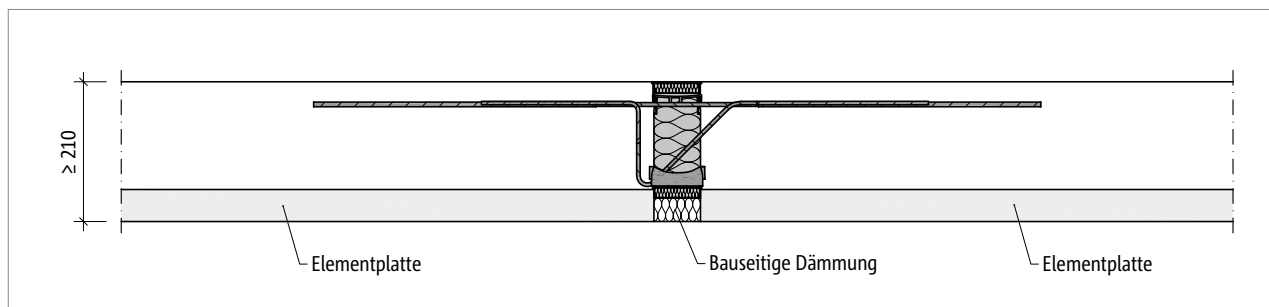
Schöck Isokorb® T Typ KL: Elementdecke mit aufgesetzten T Typ KL
